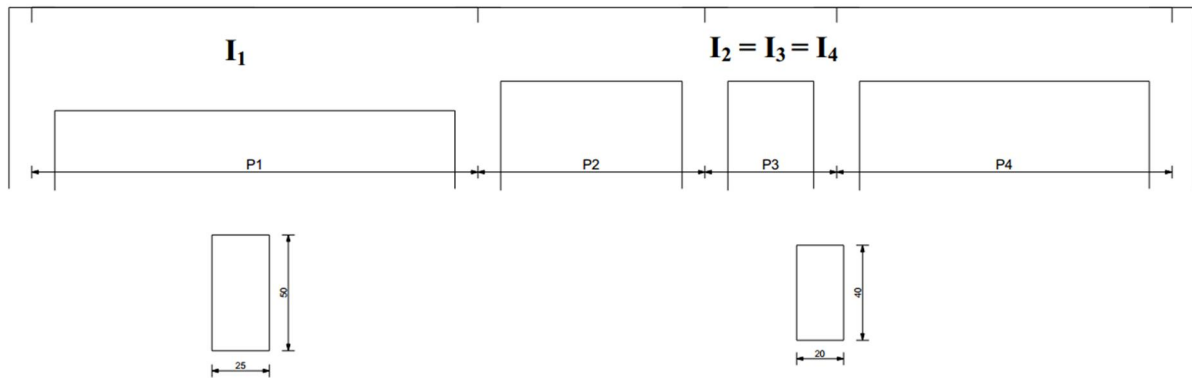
schéma des poutres sur la file X15-PH-R+2
